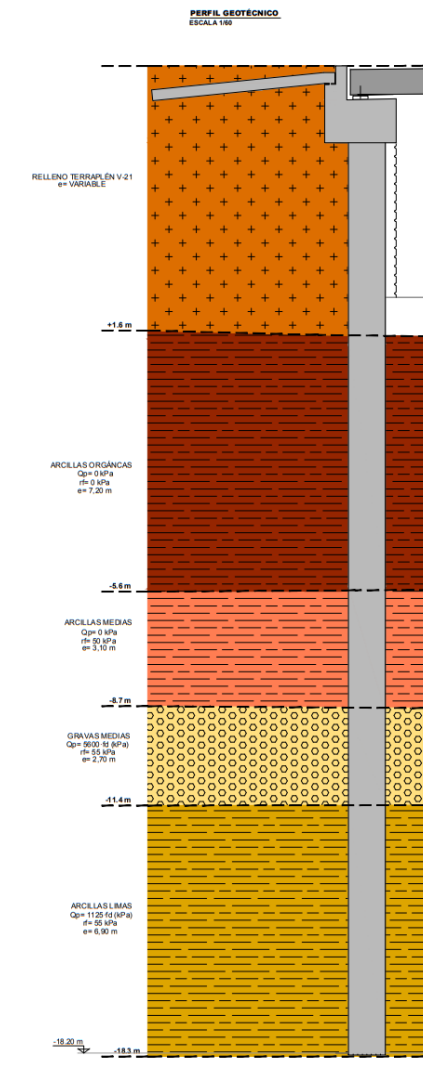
Detalle cimentación Ampliación Viaducto sobre FFCC Valencia- Barcelona. Fuente: Proyecto de construcción
